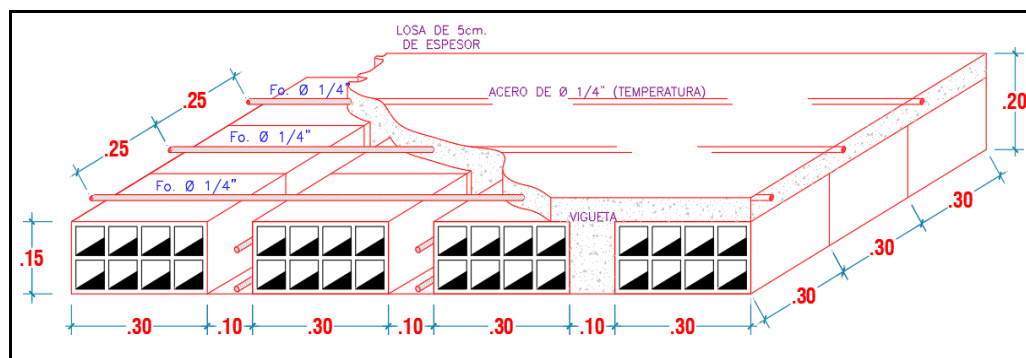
Detalle típico de losa aligerada. Elaboración propia
